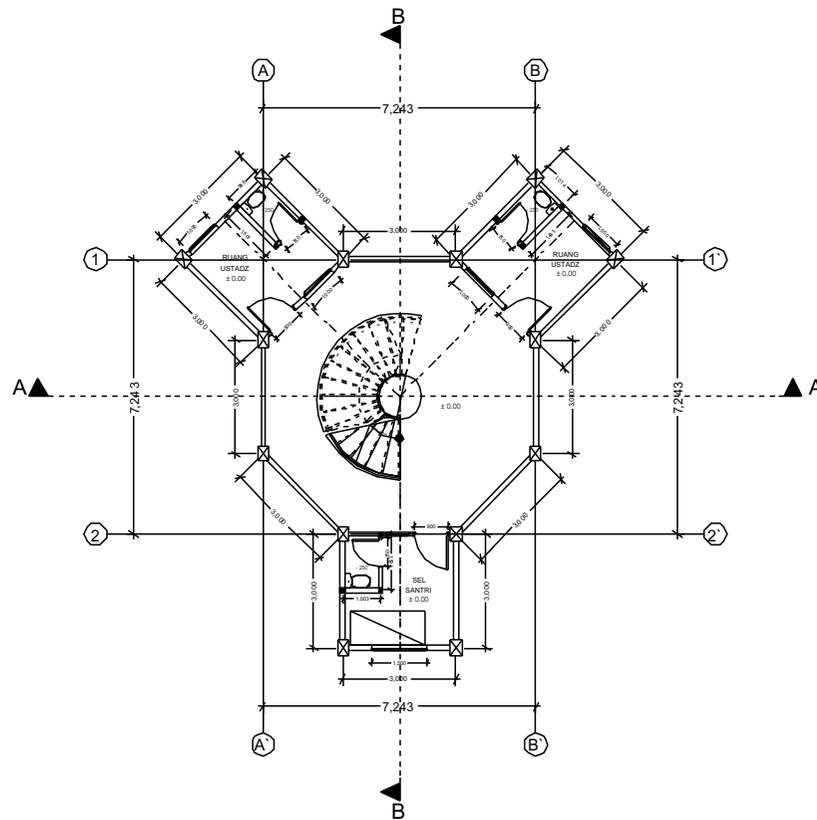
Komplek Blok Pondok Pesantren LAPAS
